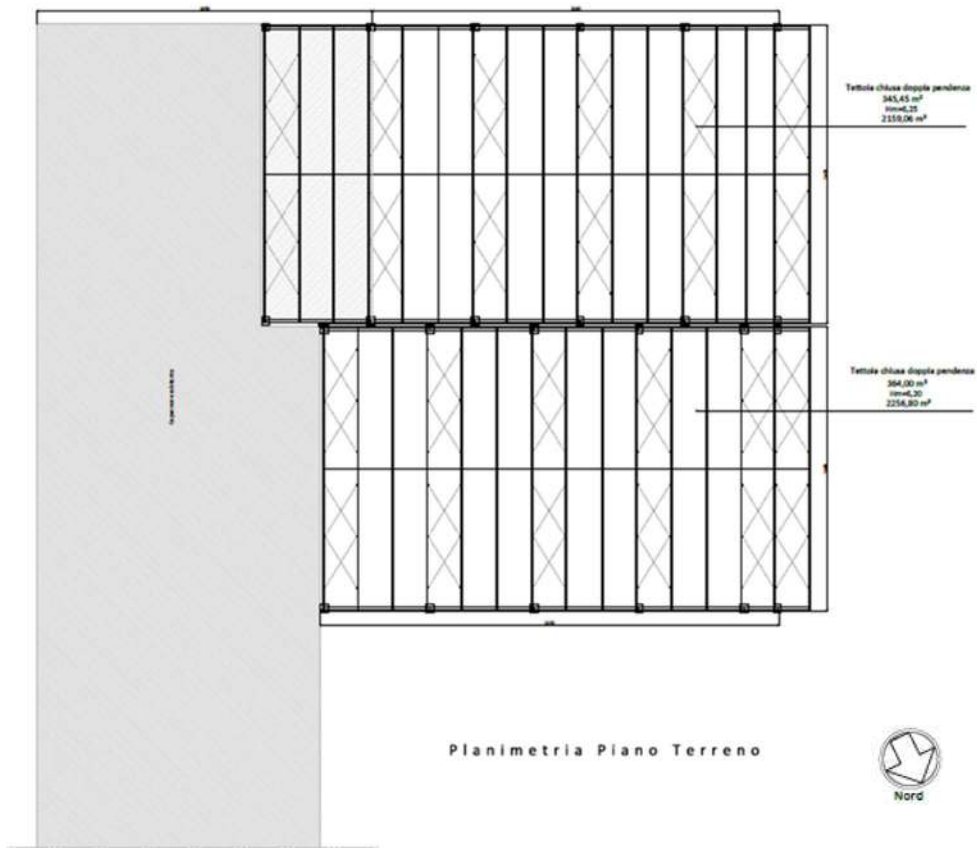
Pianimetria piano terreno dell'ampliamento in progetto
